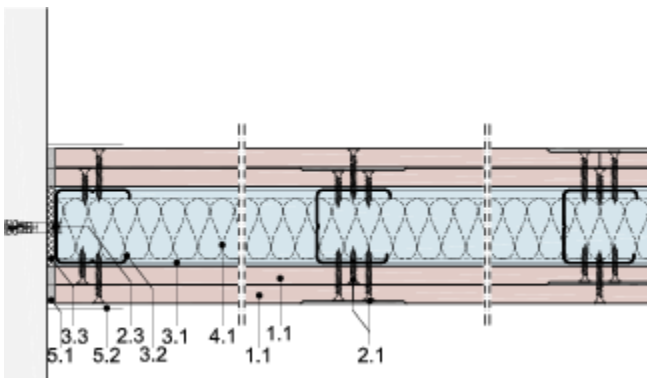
Gleitender Deckenanschluss Doppelständerwand
